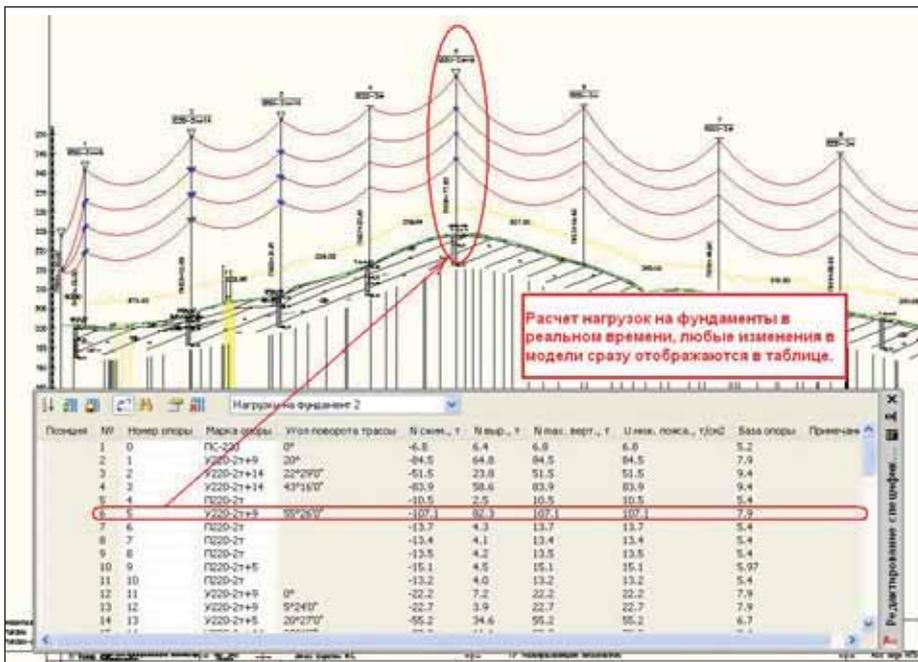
Расчет нагрузок на фундаменты опор в реальном времени
